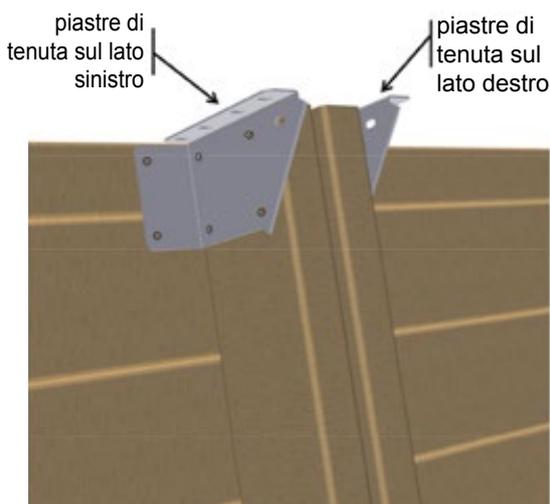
Posizionamento delle piastre di tenuta nella parte superiore dei pali di fondazione
